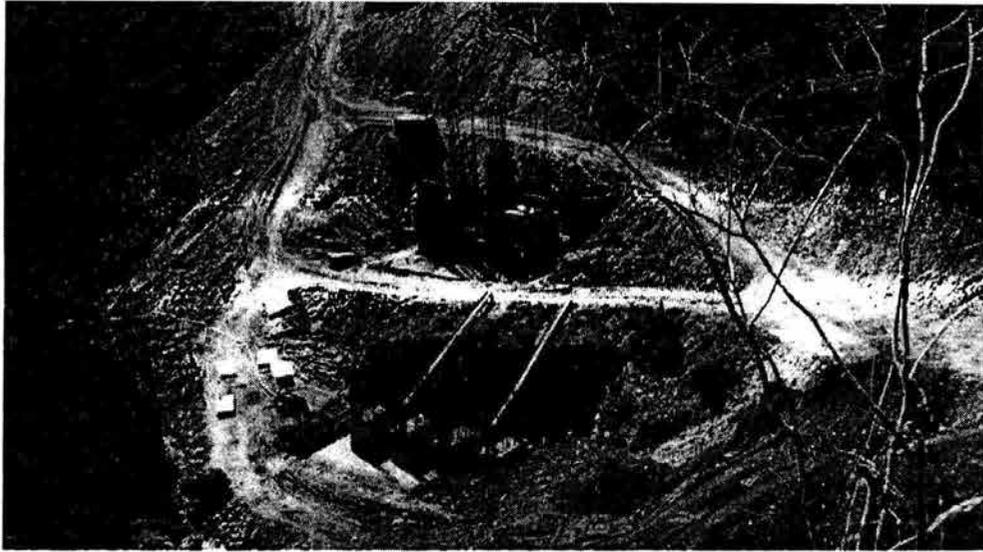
Vista primer Trepado Pila #4 y segundo Pila #5
